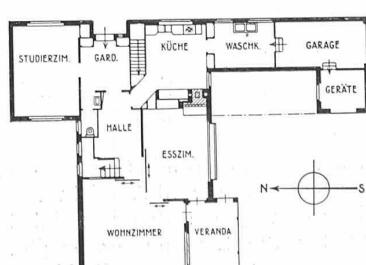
Haus Tobler 1929. Grundriss 1 : 400.
